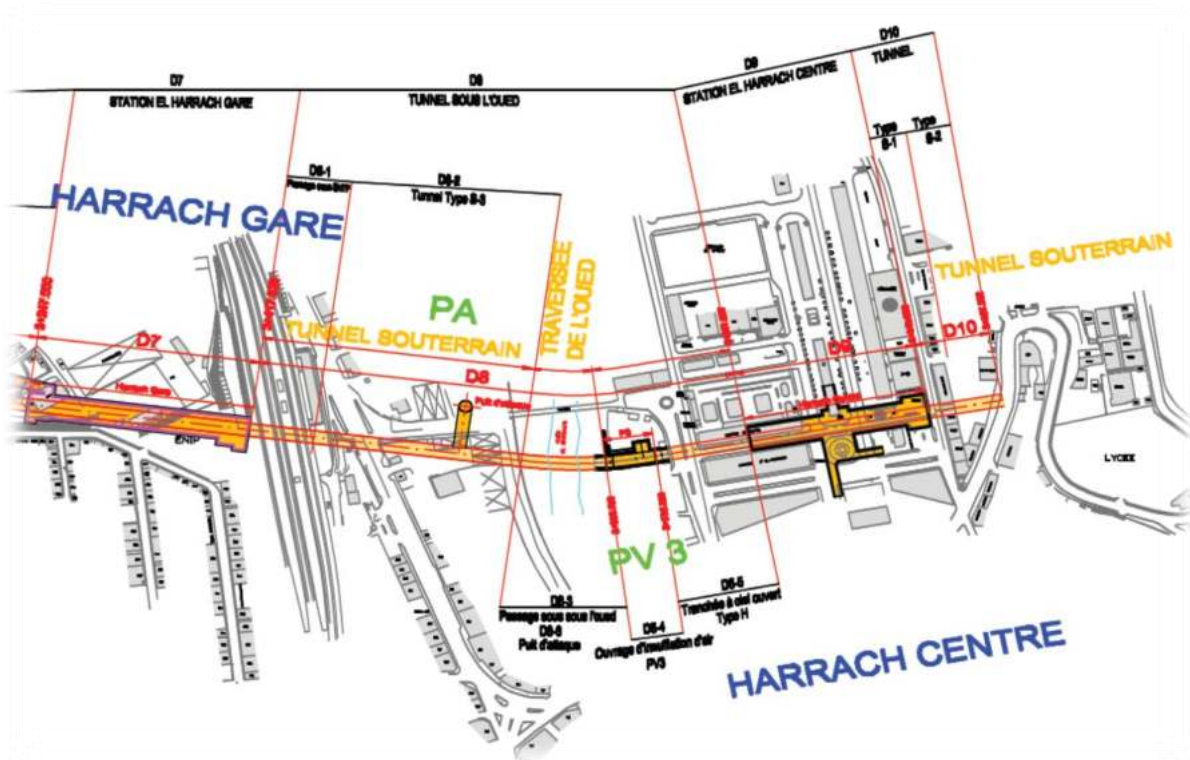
Plan d'implantation de l'ouvrage vue en plan
